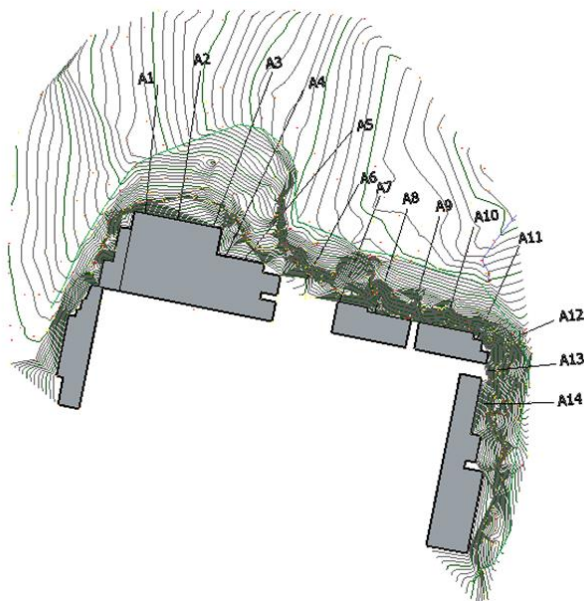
Planta del levantamiento topográfico. Fuente: [23]
